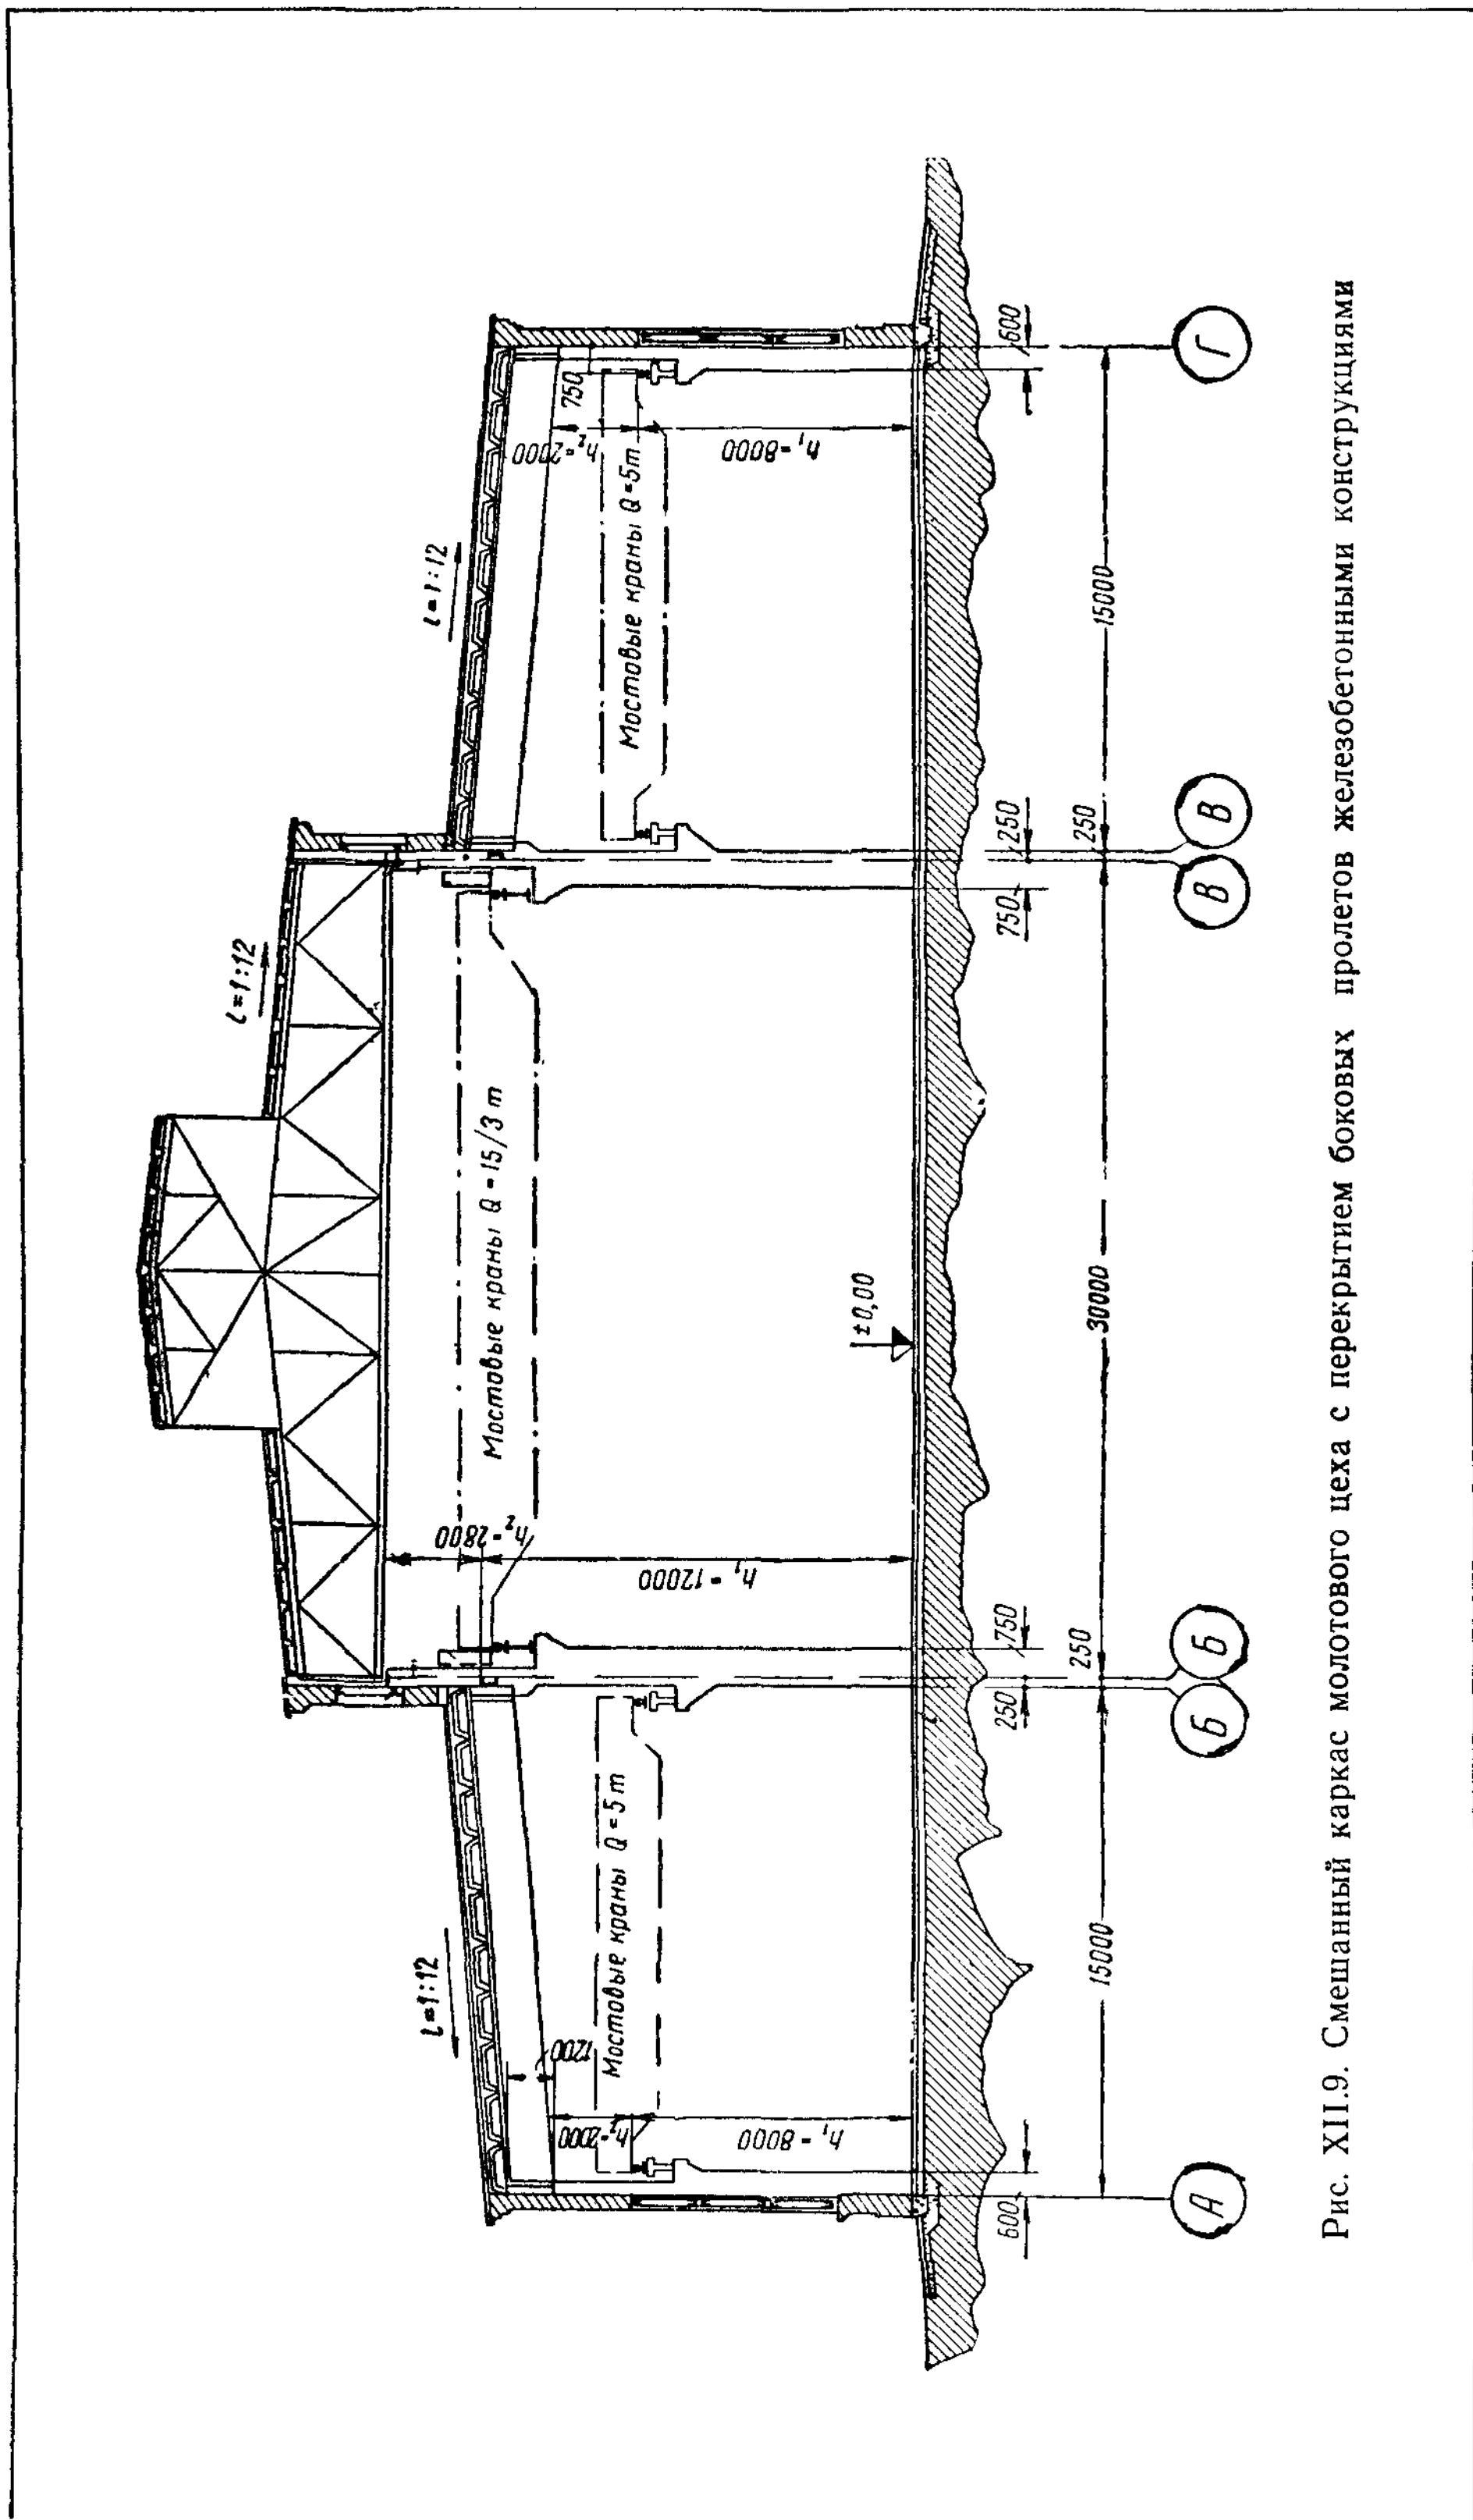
Смешанный каркас молотового цеха с перекрытием боковых пролетов железобетонными конструкциями
